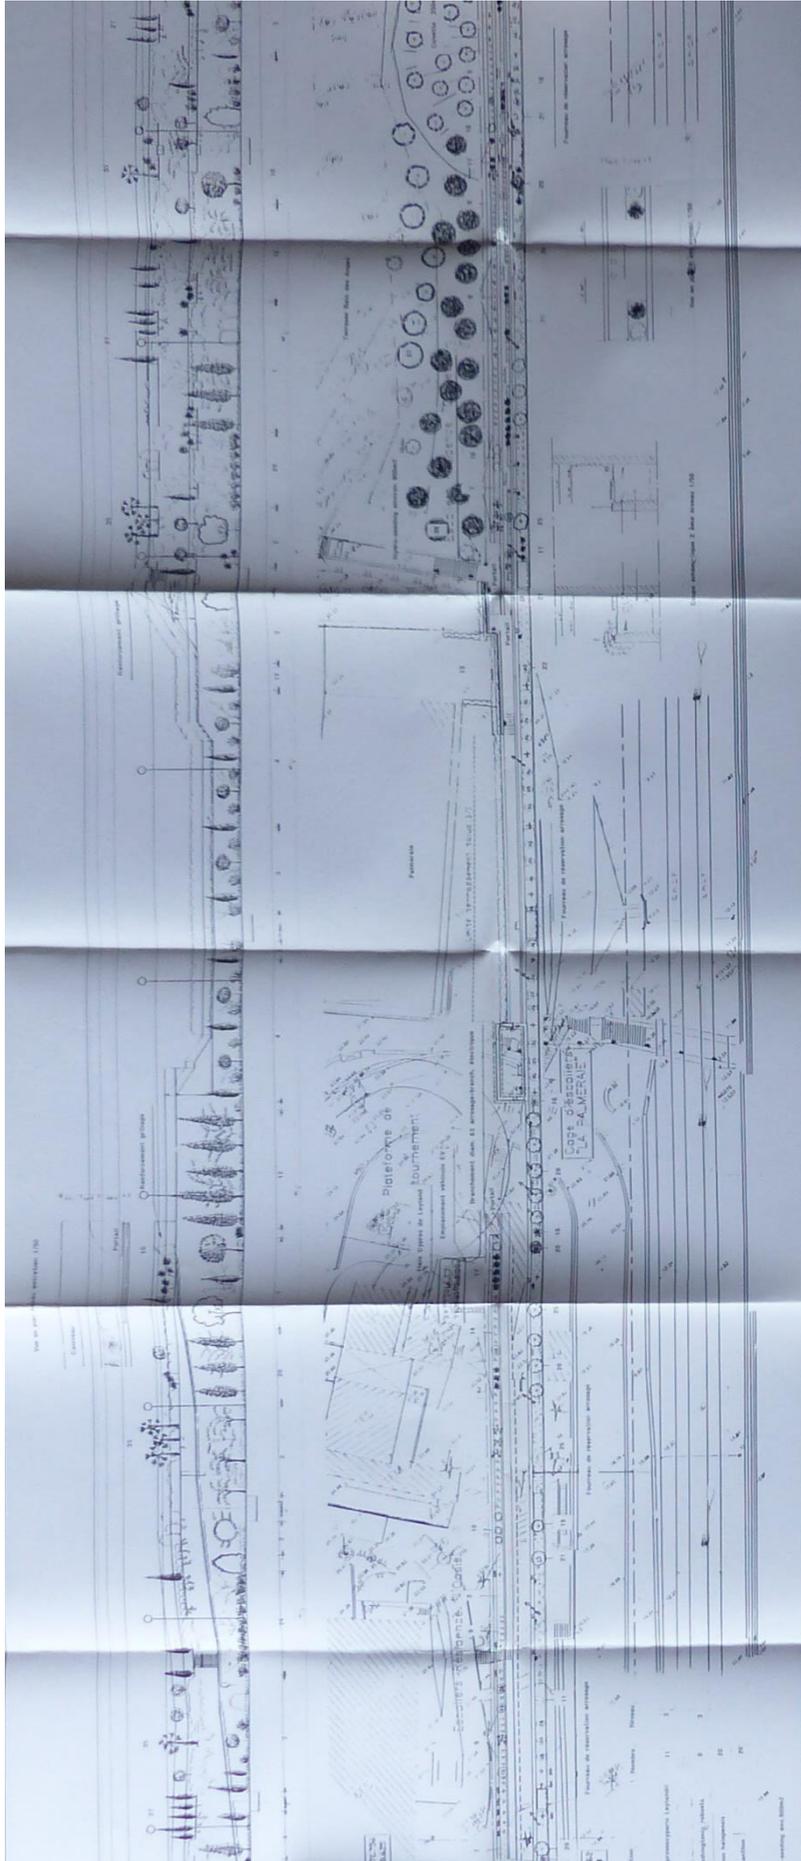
Plan de la future chaussée nord. En haut est représentée une coupe de profil avec la végétation se trouvant en hors-ligne. En bas la chaussée est représentée vu du ciel. AM, 872W5.
